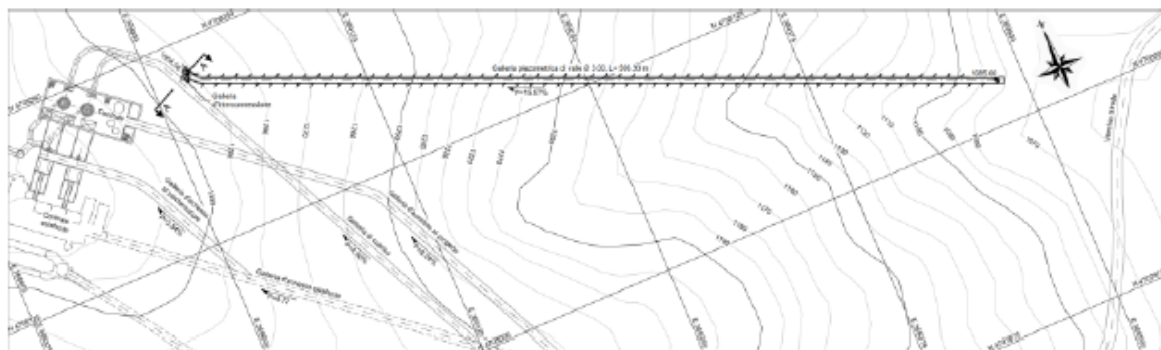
Nuova galleria sulla derivazione Provvidenza – planimetria
